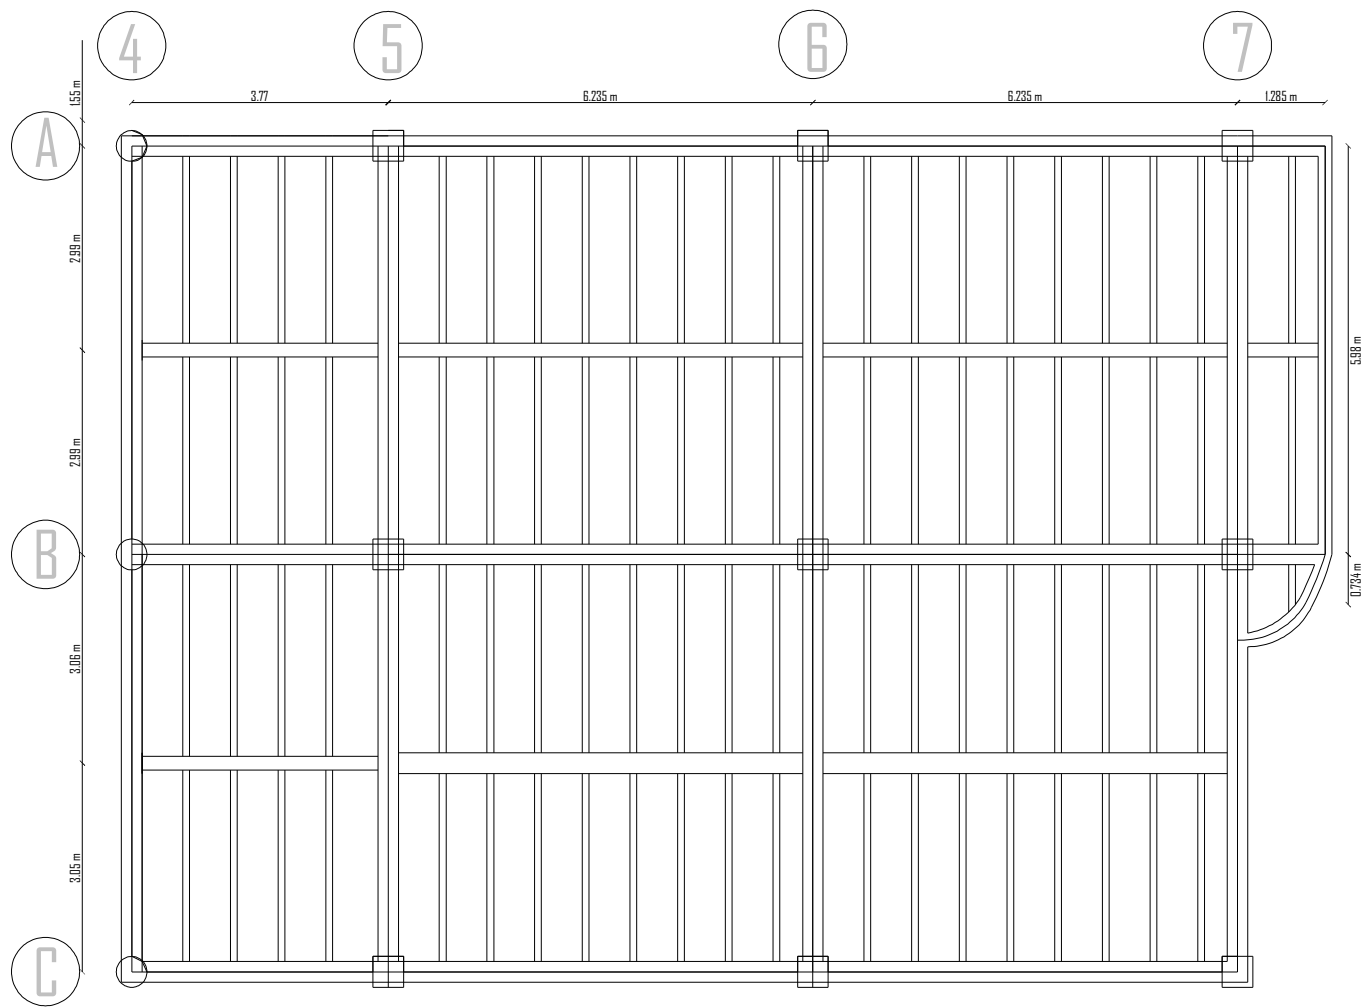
Secciones en planta de columnas, vigas, viguetas entre piso piso dos, bloque dos
